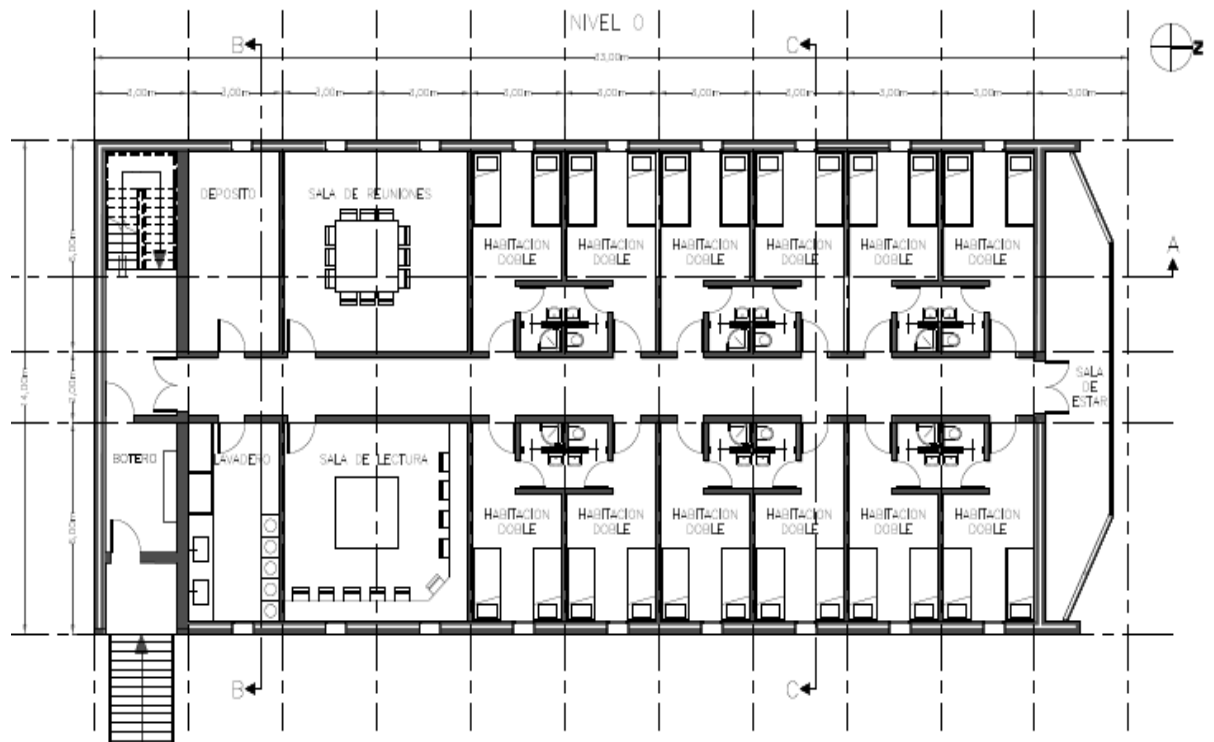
vista en planta del nivel 0 del Edificio de Laboratorios
